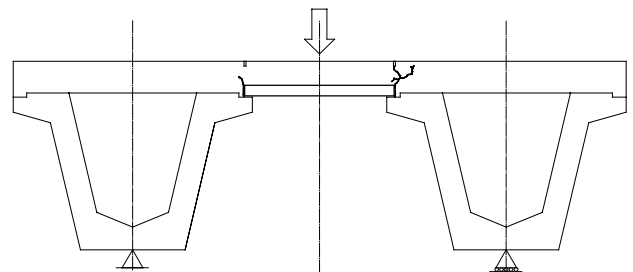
ひび割れ状況(疲労・588万回繰返し後)
